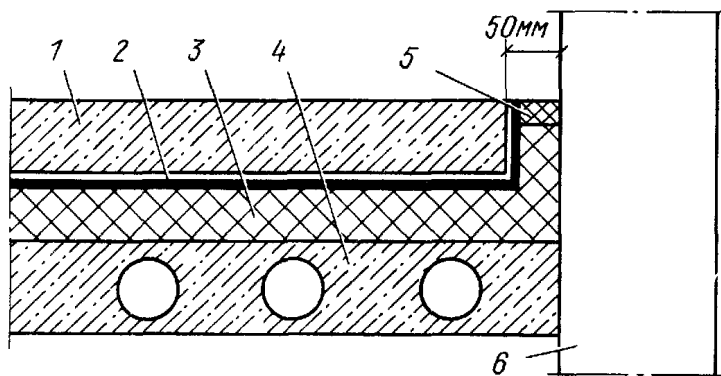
Конструкция пола на упругом основании и его стыка со стеной
